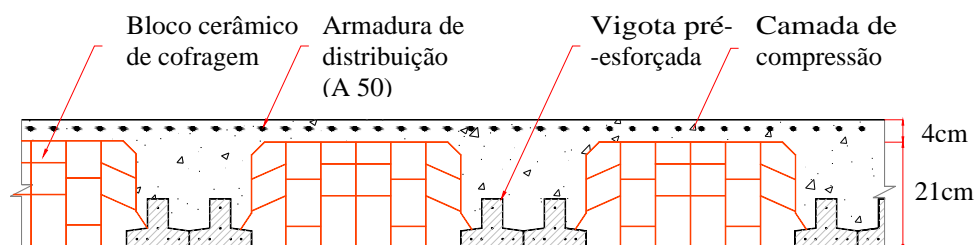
Pavimento aligeirado de vigotas pré-esforçadas e blocos cerâmicos de cofragem, sem isolante (Pav1 - solução de referência)
